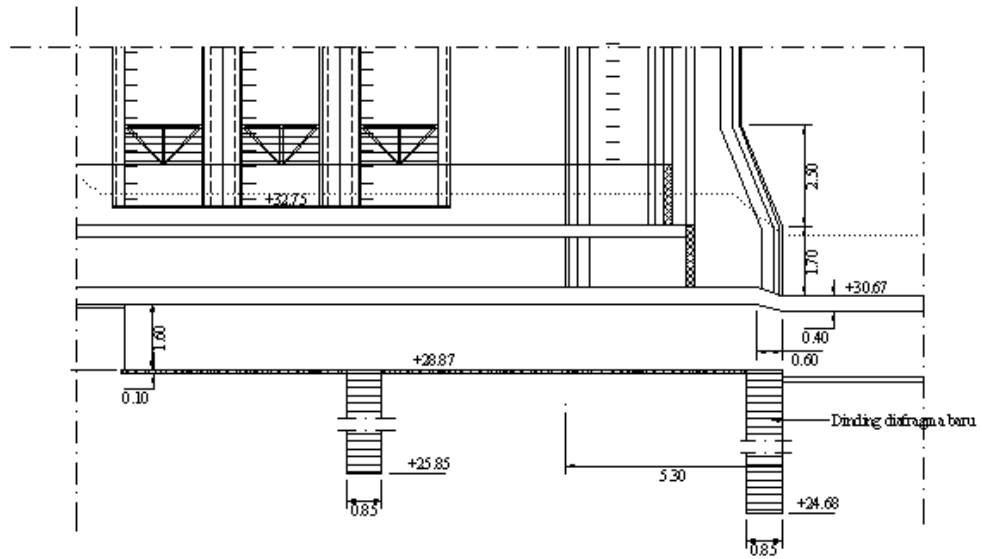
Timbunan tanah pada Saluran Pengambilan
